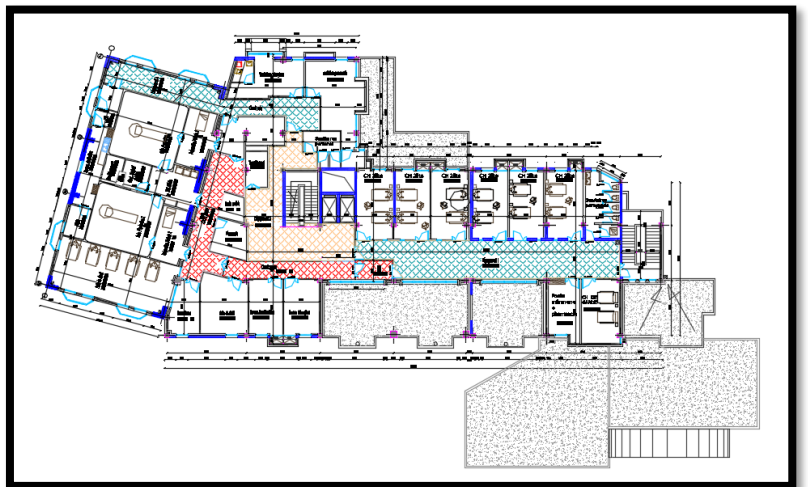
Plan R+3 ; Source : BET NABIL GAHAM
